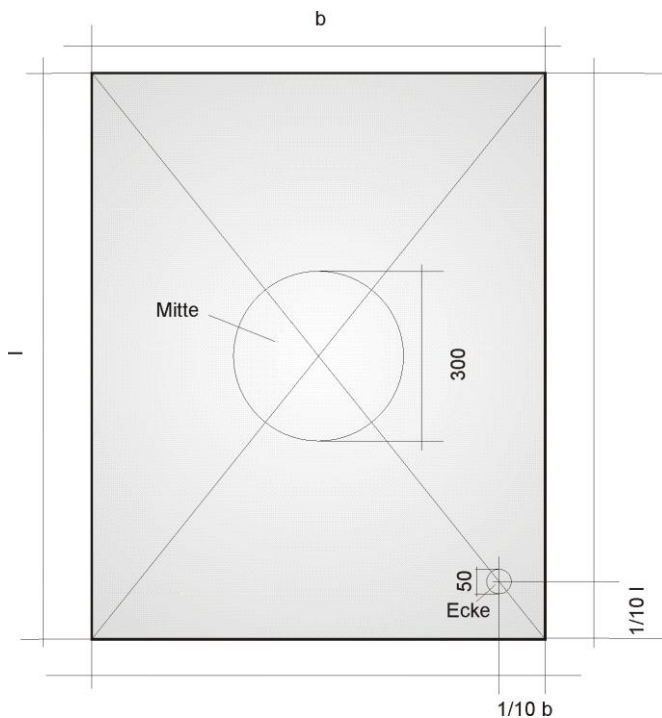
Beschussorte der Verglasung im Grundriss (Masse in Millimeter)
